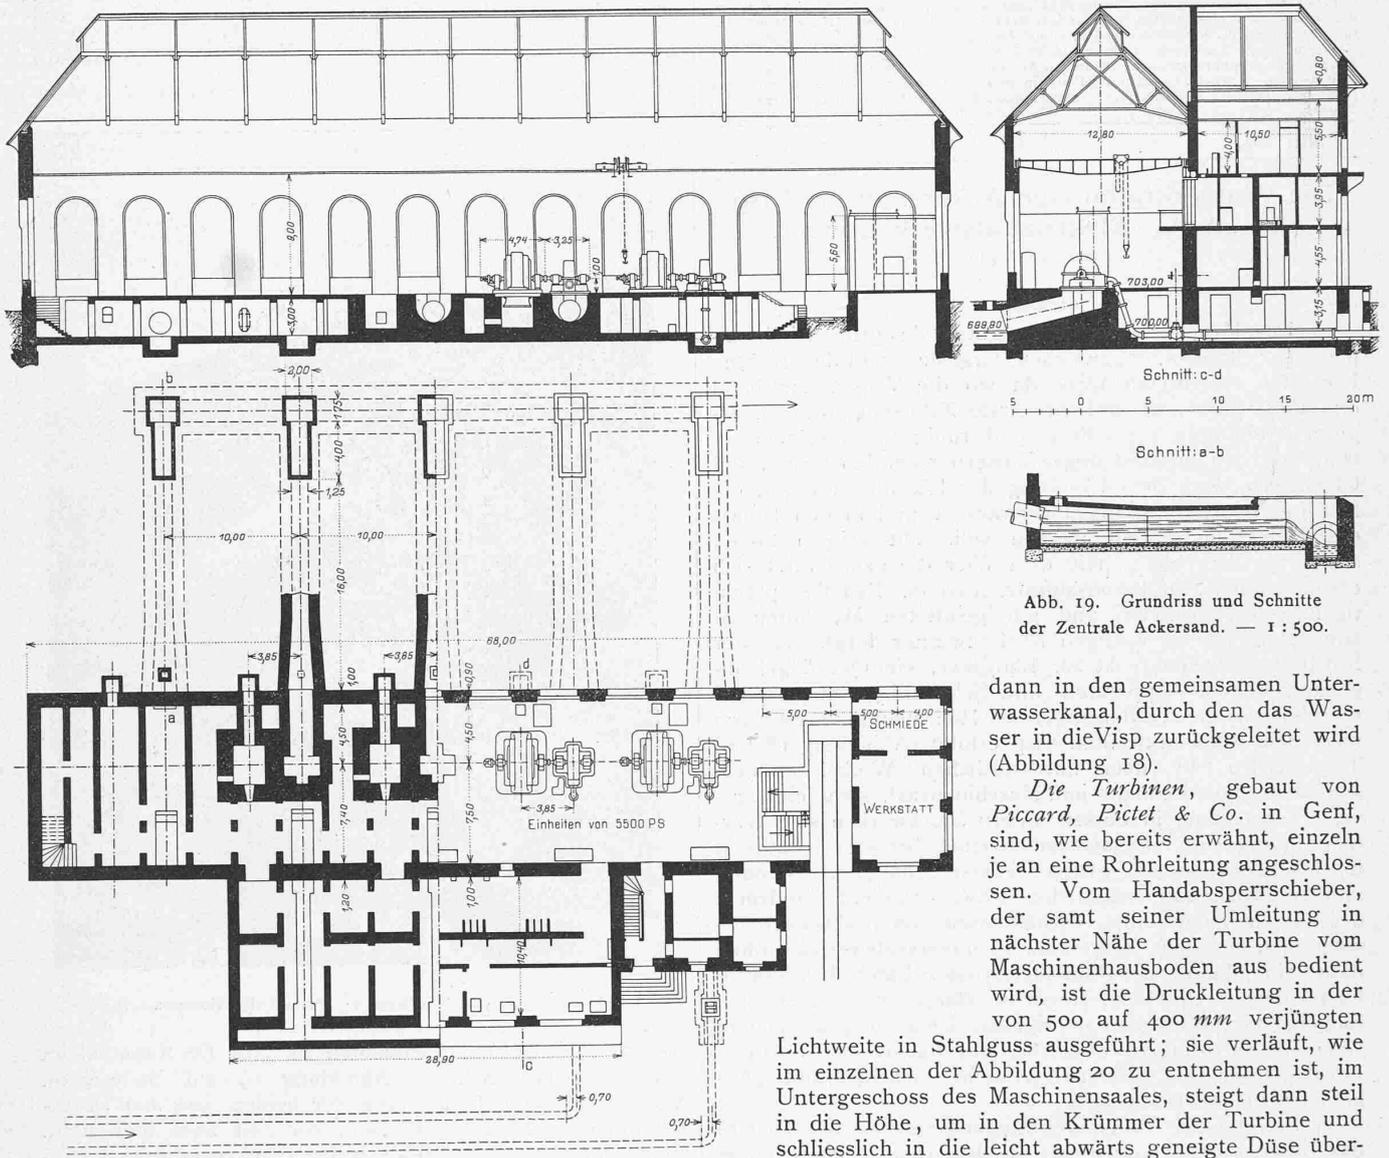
Grundriss und Schnitte der Zentrale Ackersand. — 1 : 500.
